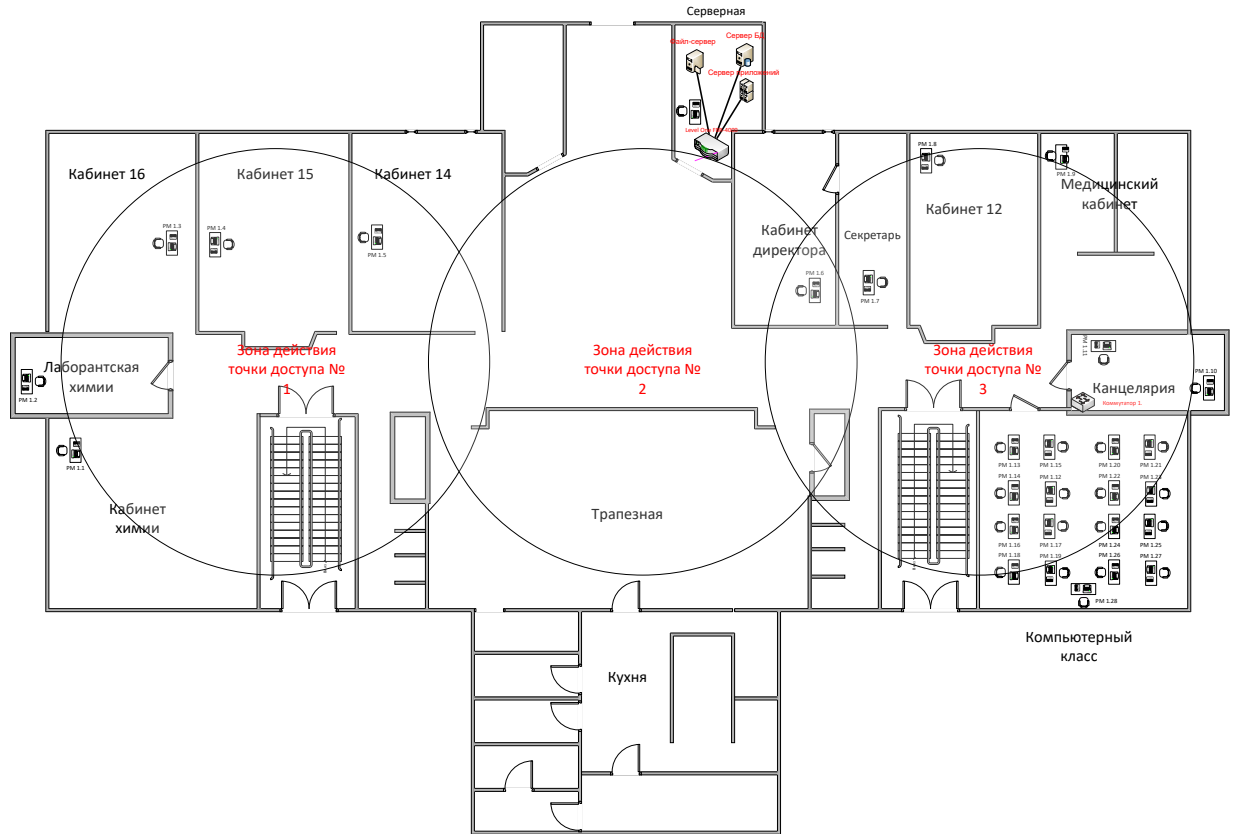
Схема размещения элементов сети на плане 1 этажа
